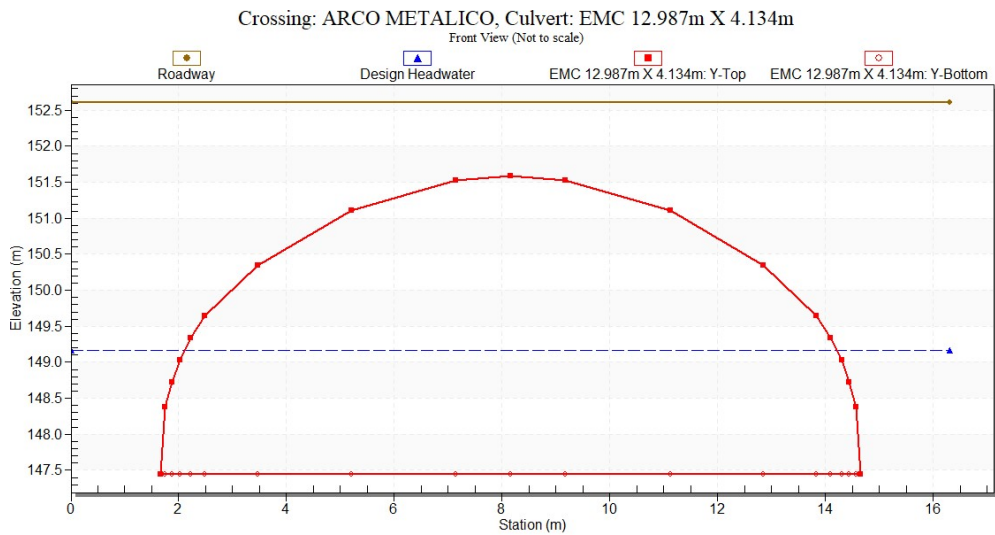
Esquema del flujo en vista frontal de la estructura metálica corrugada. Fuente:
